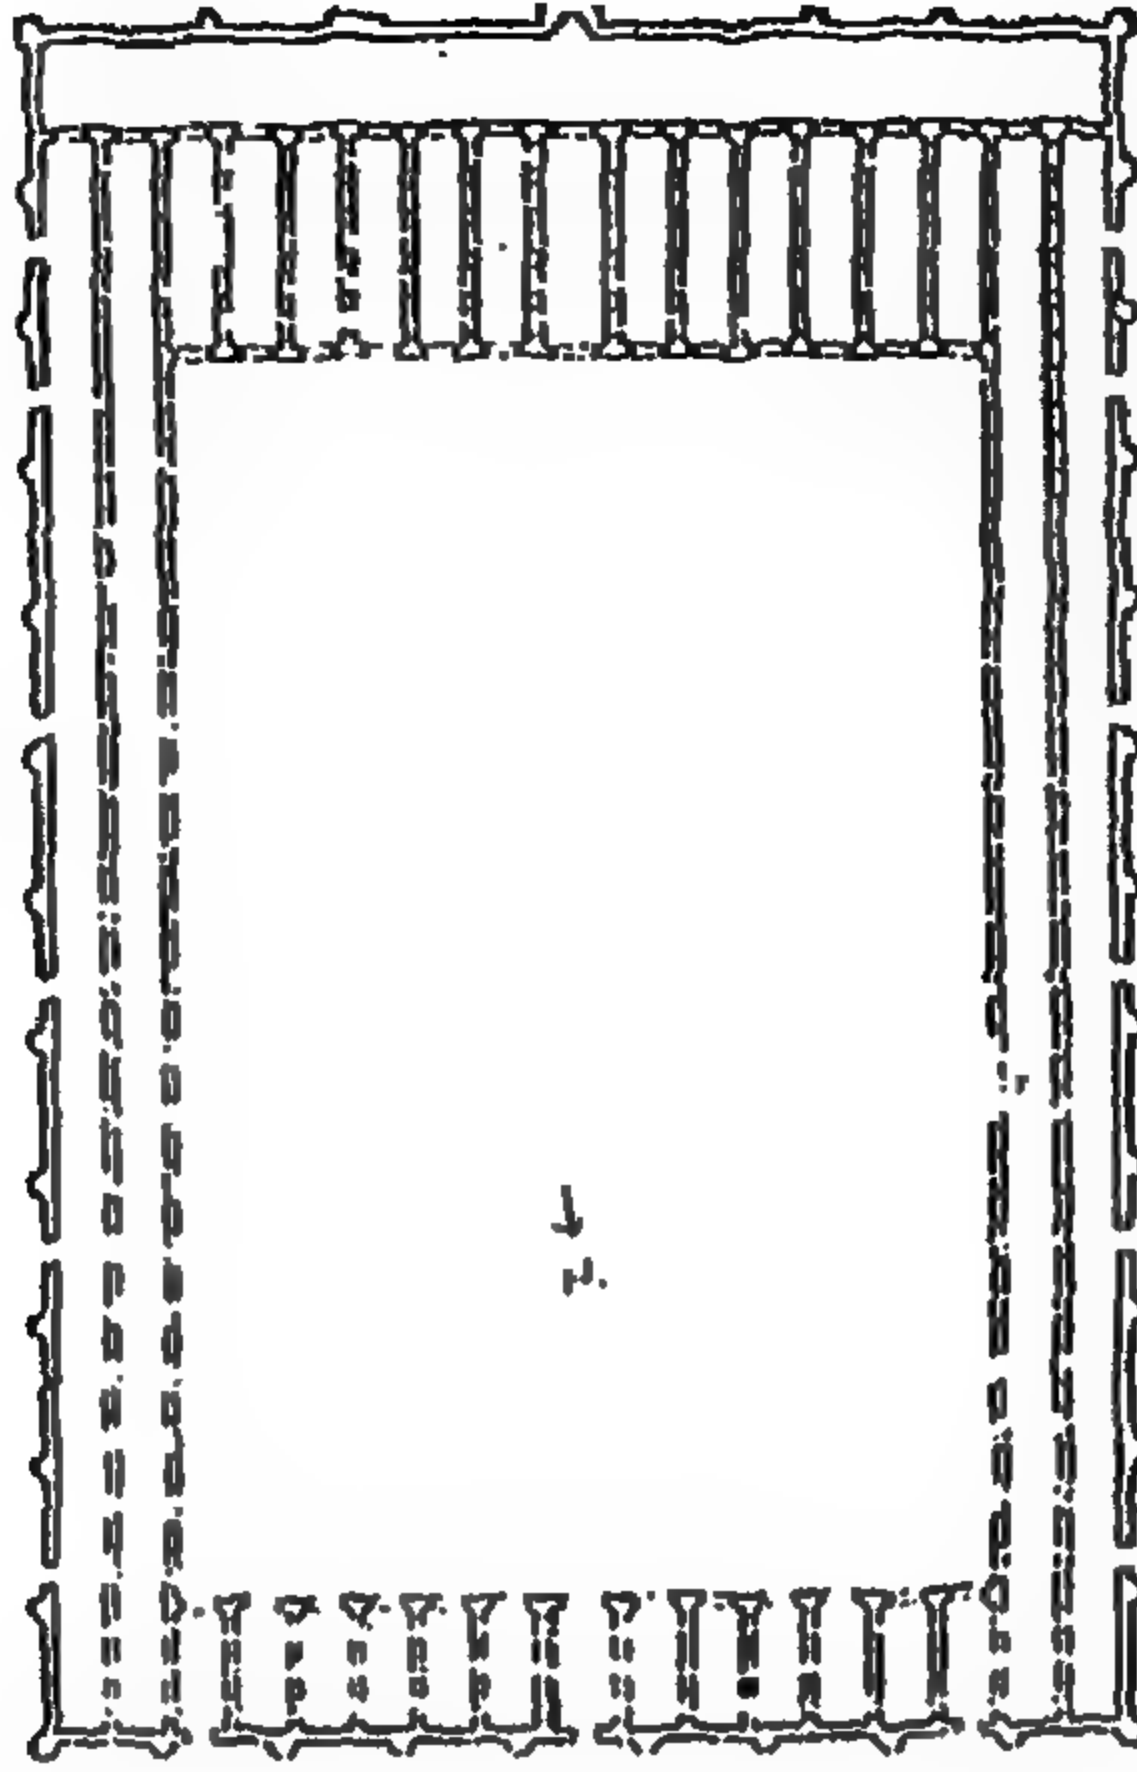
مسقط أفقي لجامع قرطبة (عن : Moreno)
